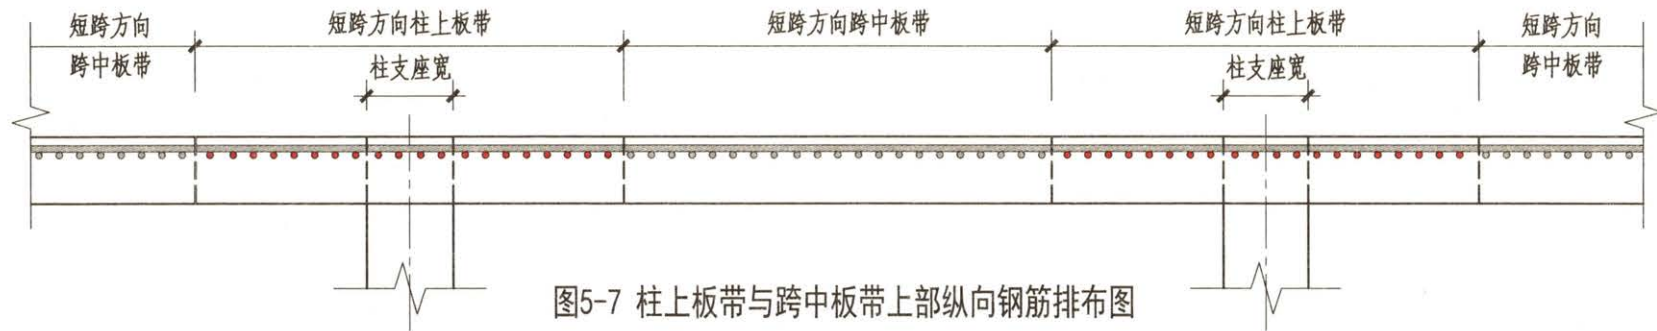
柱上板带与跨中板带上部纵向钢筋排布图
